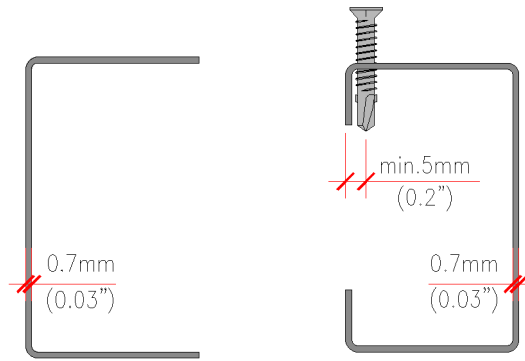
Secção tipo de estrutura em aço galvanizado
